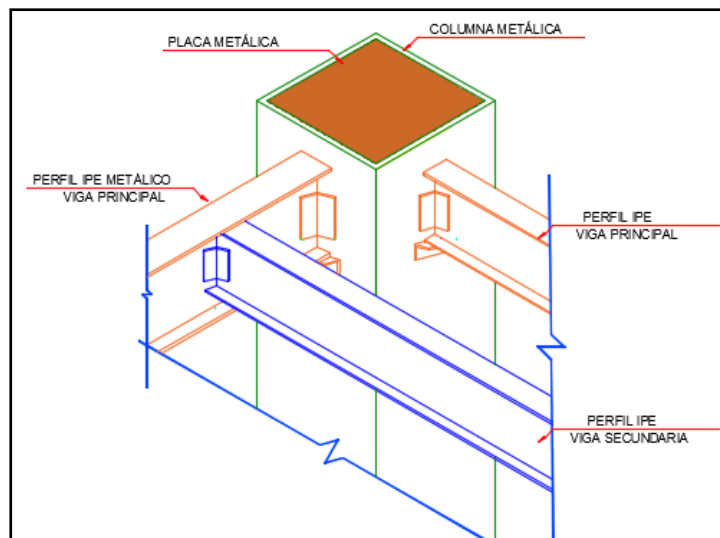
Vista isométrica de conexión entre vigas y columnas [Carreño J., Cañarte J., 2019]
